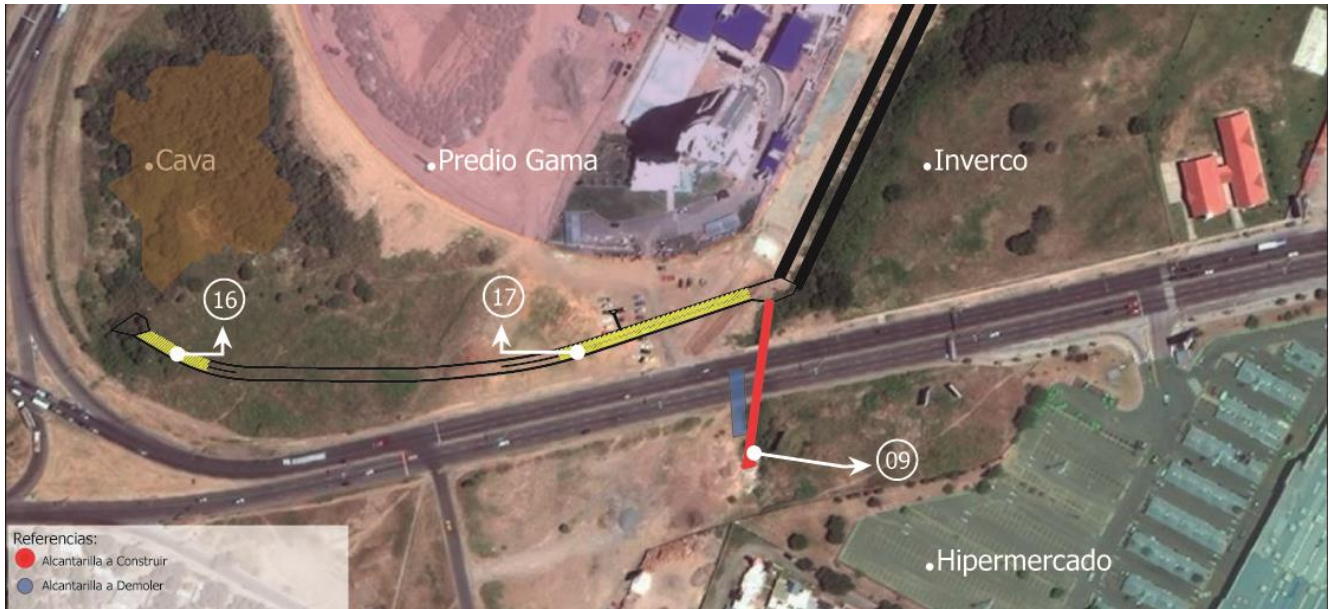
Ubicación alcantarillas 17 y 9.
